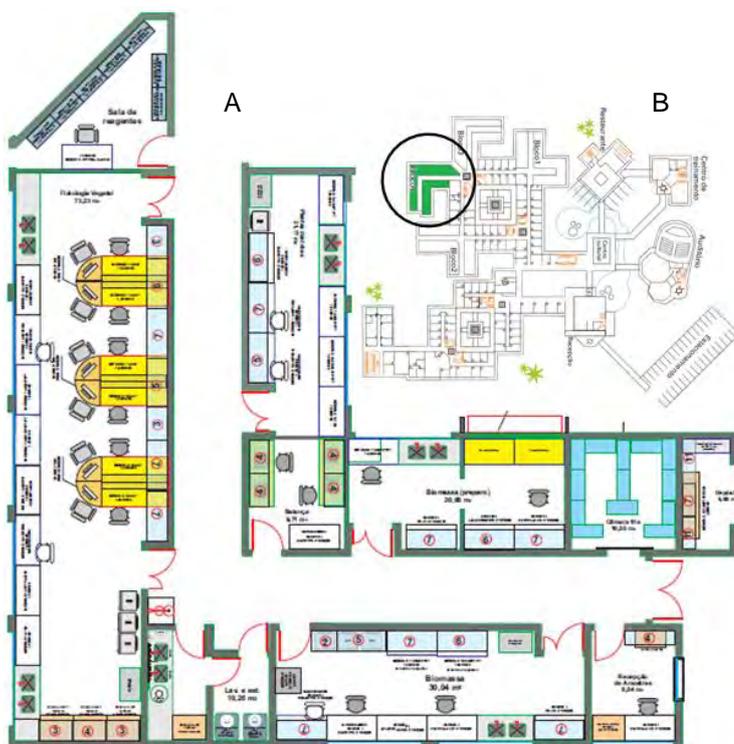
Planta baixa do Bloco 4 (A); planta baixa da Sede da Embrapa Agrossilvipastoril com destaque em verde para a localização do Bloco 4 (B).
